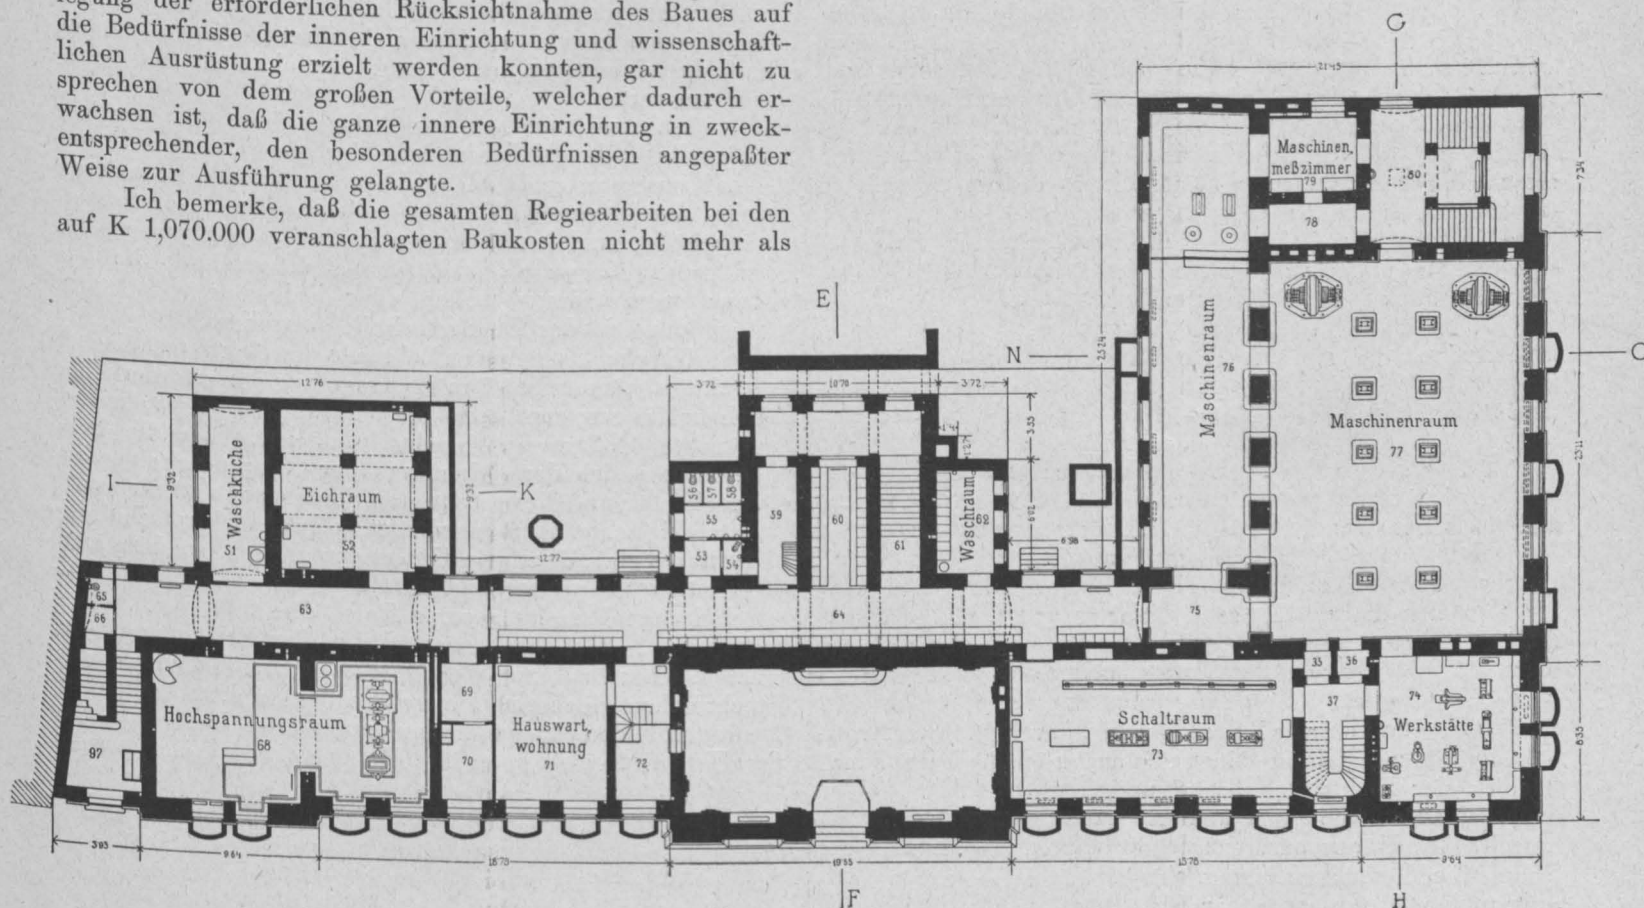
Grundriß des Sockelgeschosses. Maßstab 1:400.
